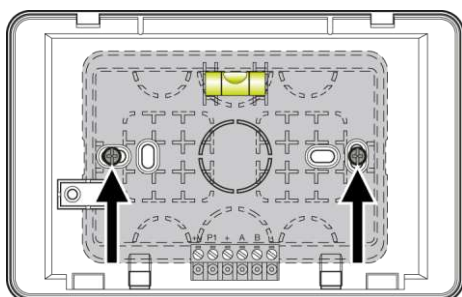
Fixation sur boîtier à encastrer rectangulaire 3 places
